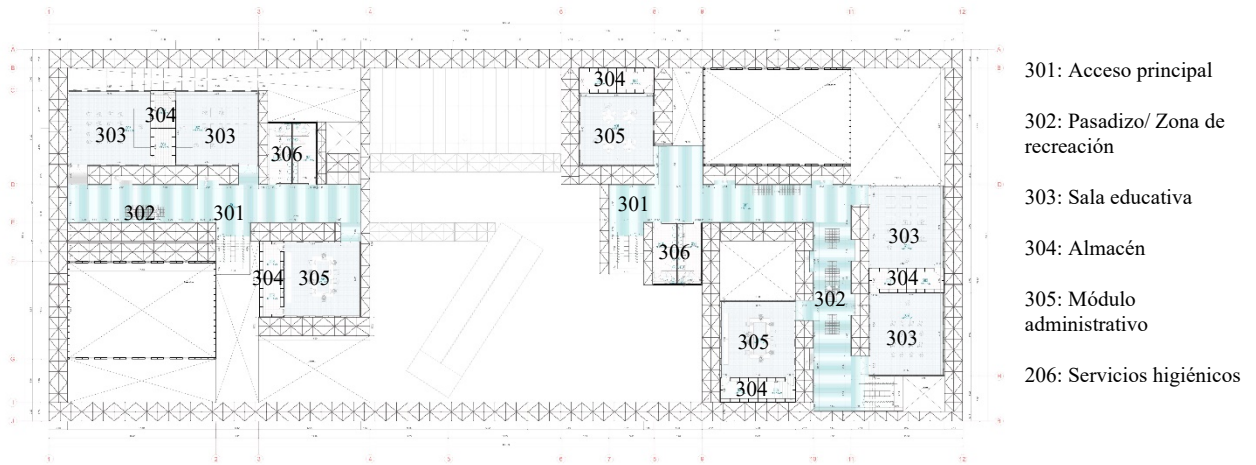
Planta tercer nivel. Fuente: Elaboración propia
